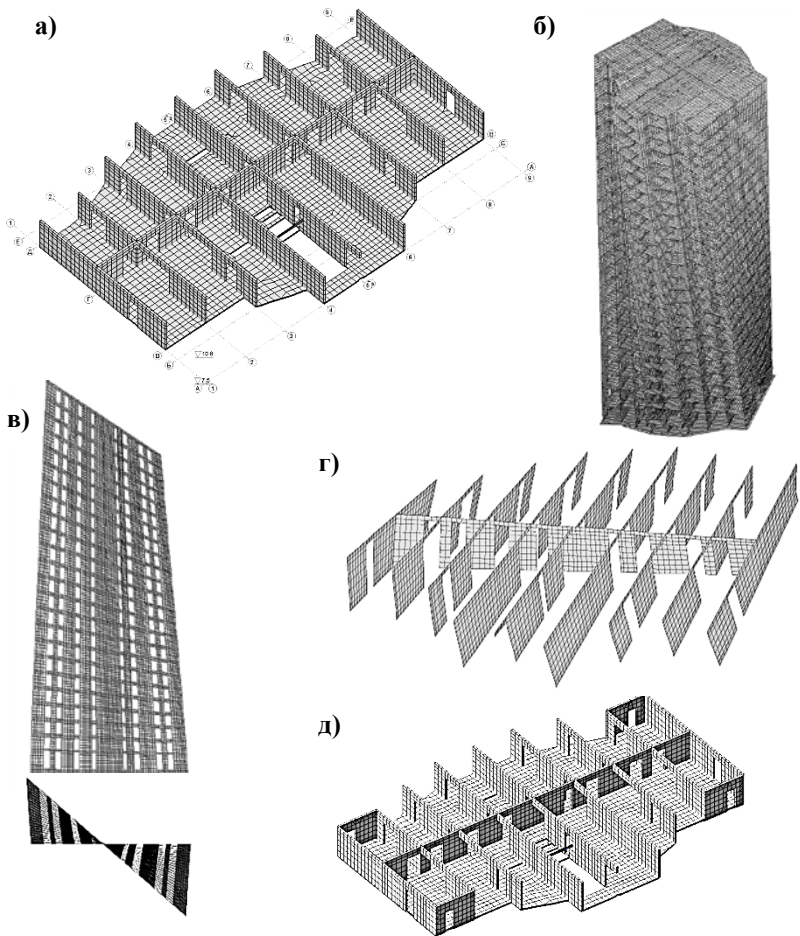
24-х этажное здание гостиницы, запроектированное с применением туннельной опалубки. а – типовой этаж; б – первая форма колебаний; в – деформация продольной стены; г – деформация типового этажа; д – рекомендованная схема несущих элементов здания
